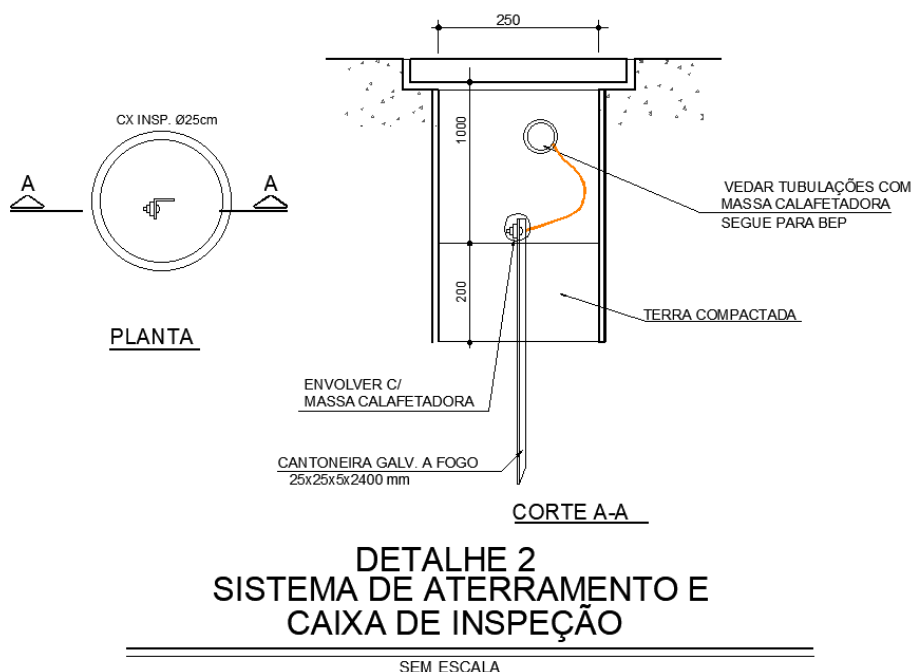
Sistema de aterramento com detalhe para caixa de inspeção.
